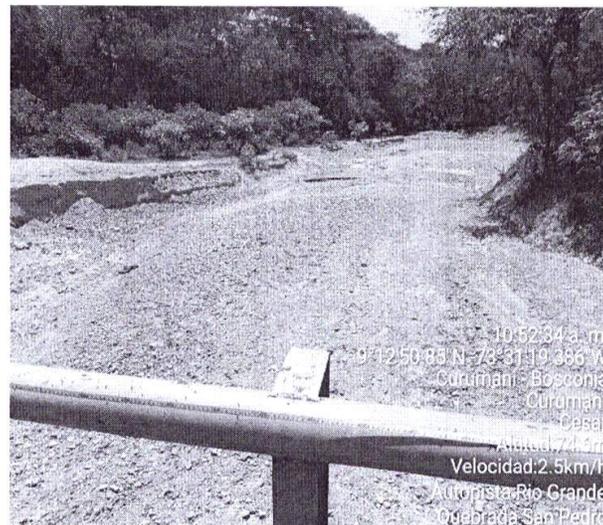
Vista general de la zona de captación propuesta sobre la Quebrada San Pedro.
